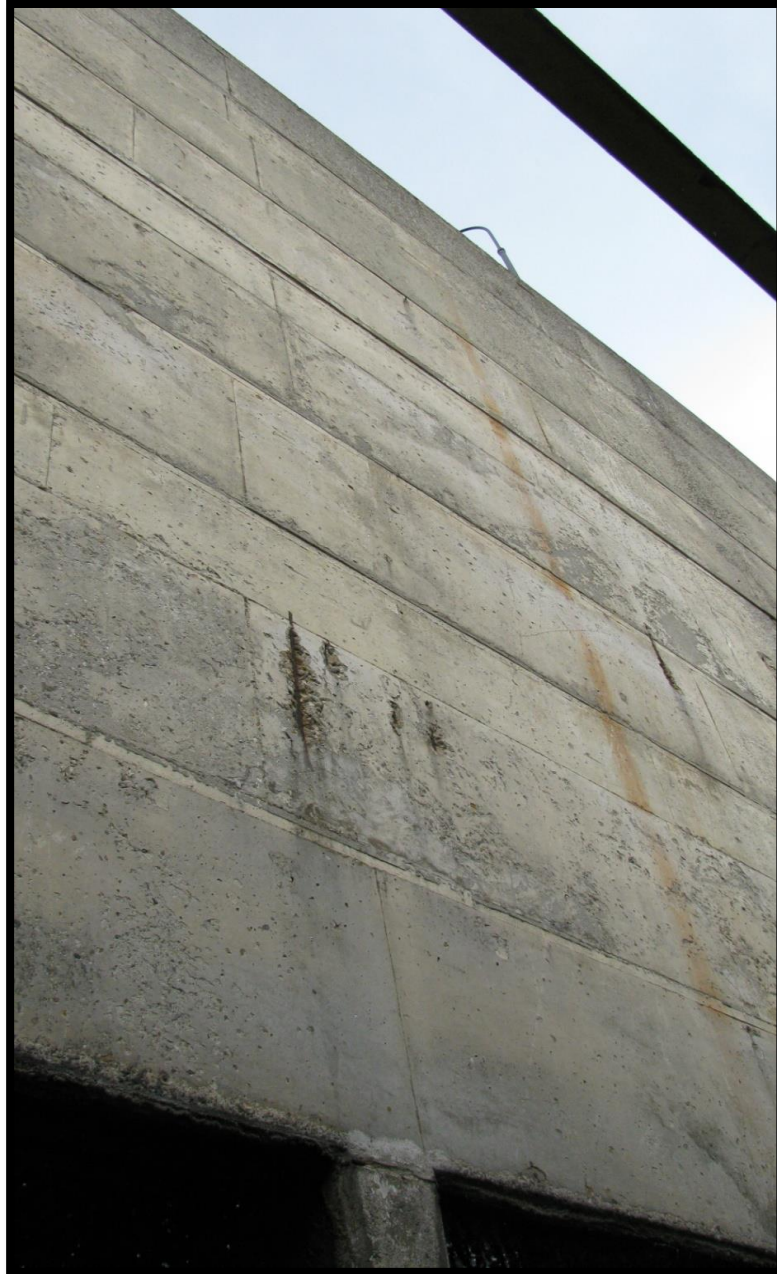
Fotografía detalle del muro superior del costado occidental (Fuente: el autor).
